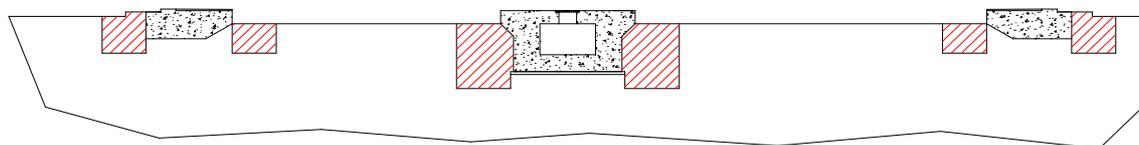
scavo trincee di accesso a sezioni periferiche e struttura centrale fondazione
